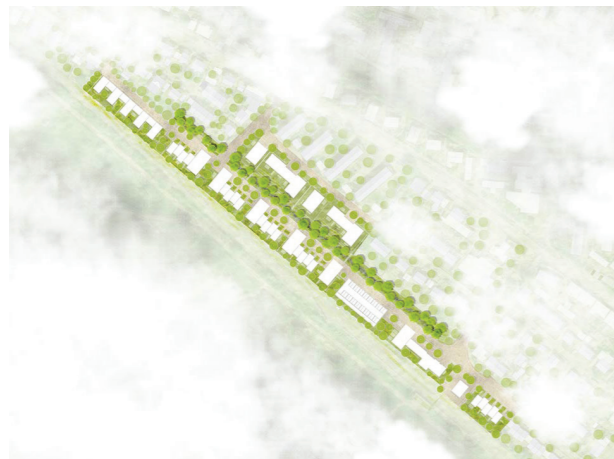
Lageplan, Güterbahnhof Ötlingen
